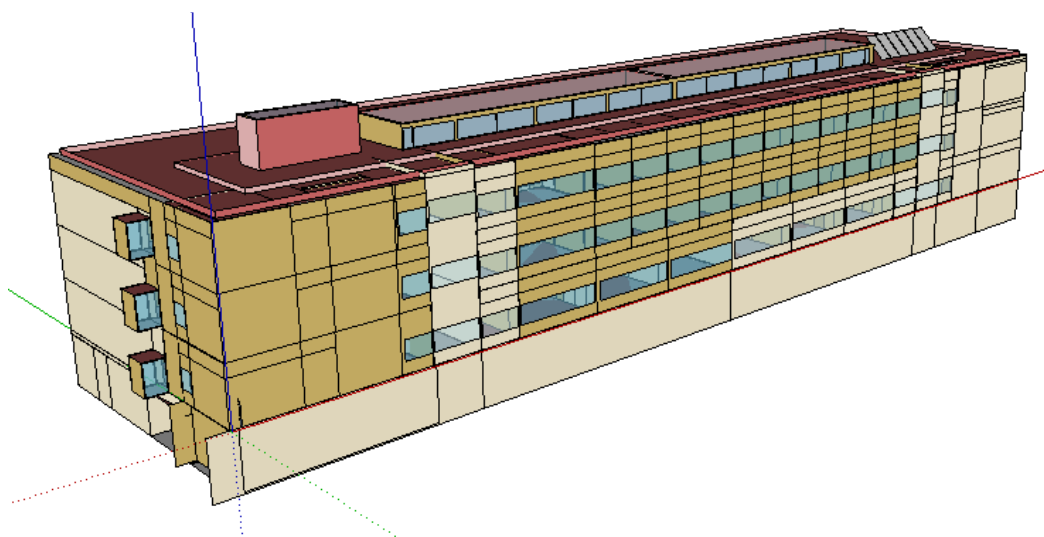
Vista das fachadas Sul e Nascente do edifício
